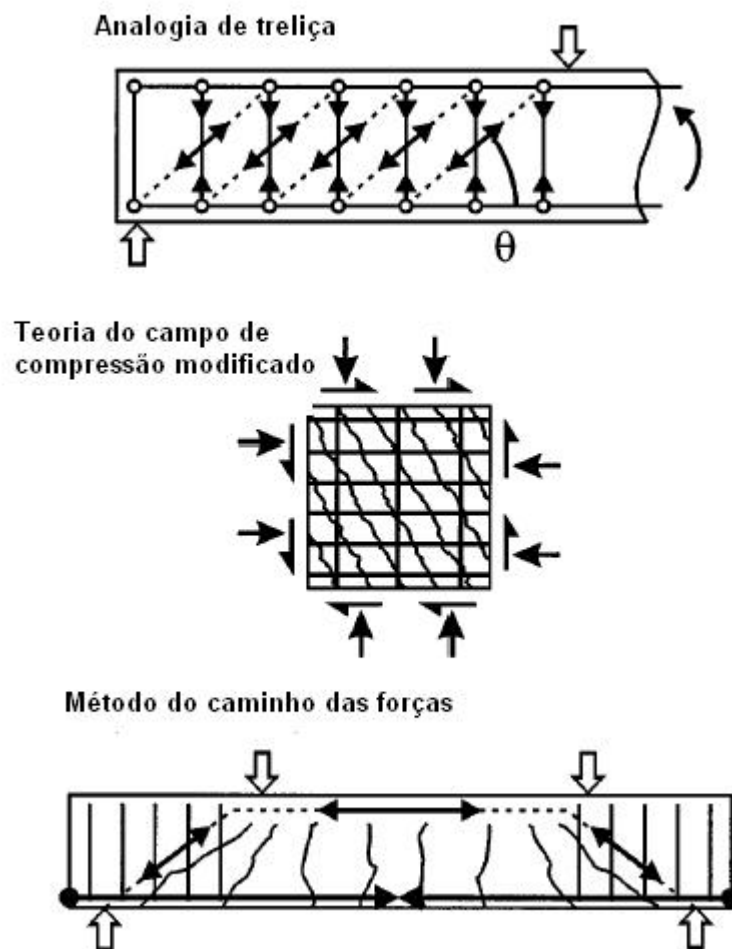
Modelos simplificados de equilíbrio no vão de cisalhamento em vigas de concreto armado (STRATFORD *et al.* 2003)
